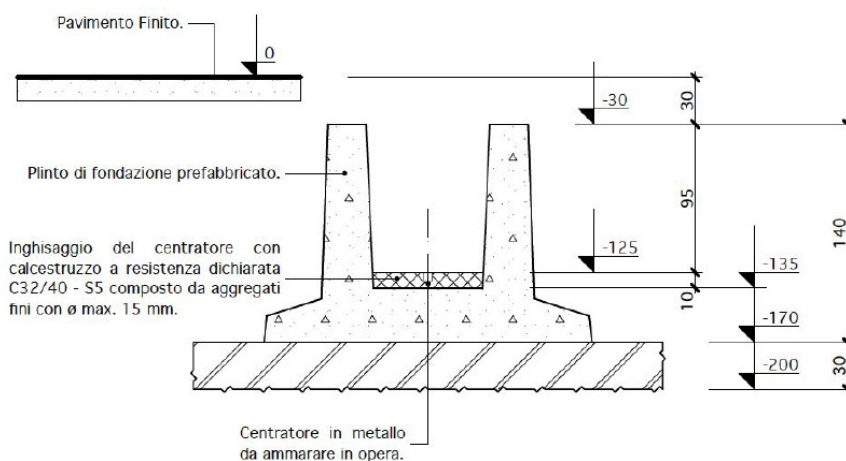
Casale Monferrato: disposizione altimetrica dei plinti di fondazione
